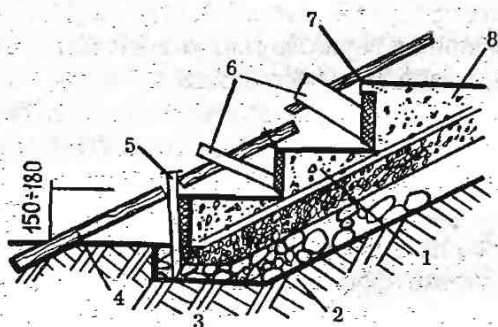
Профиль монолитной лестницы в опалубке: 1 — арматура; 2 — бутовое основание; 3 — щебень; 4 — срединная доска; 5 — колышек; 6 — упоры; 7 — металлический уголок; 8 — бетон
